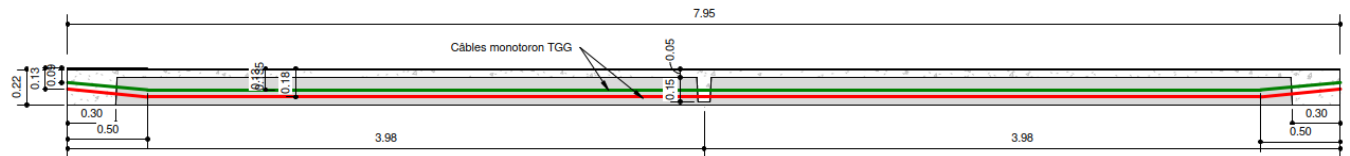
Coupe longitudinale d'un platelage de type 3 et tracé des câbles - Extrait du cahier de plans PRO
